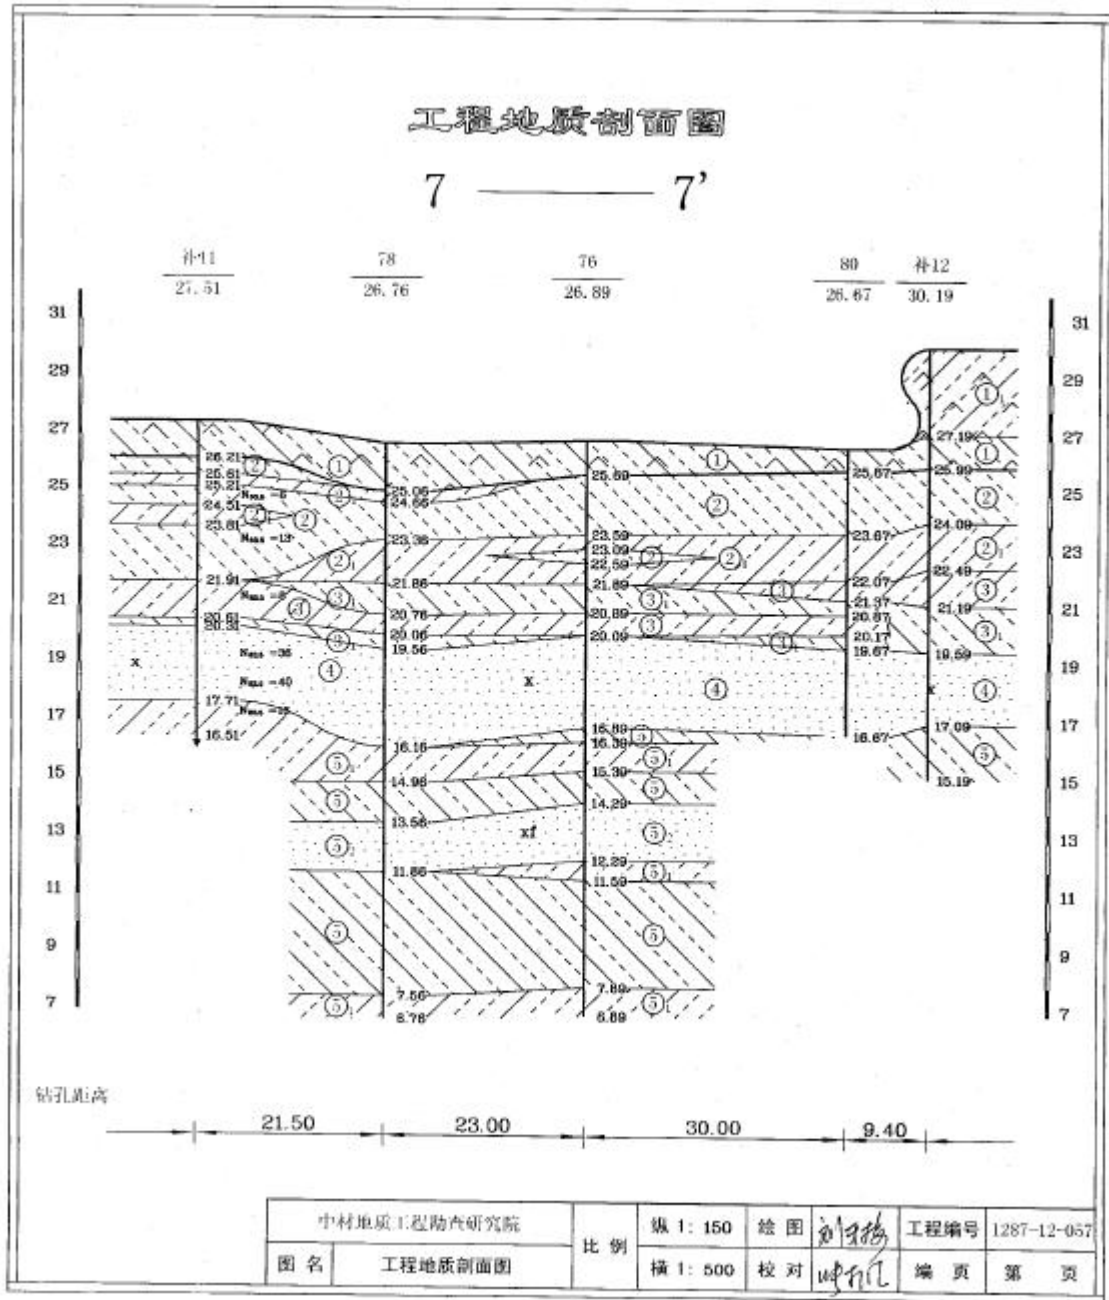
厂区地层钻孔剖面图 7-7'
